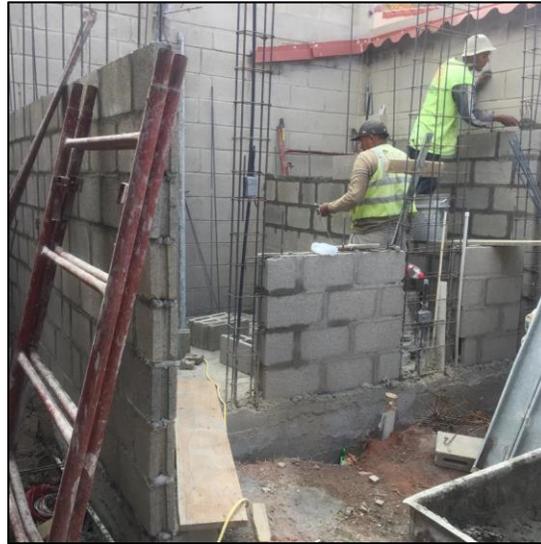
Área de lavandería en proceso de remodelación en "Villa Los Jazmines"
